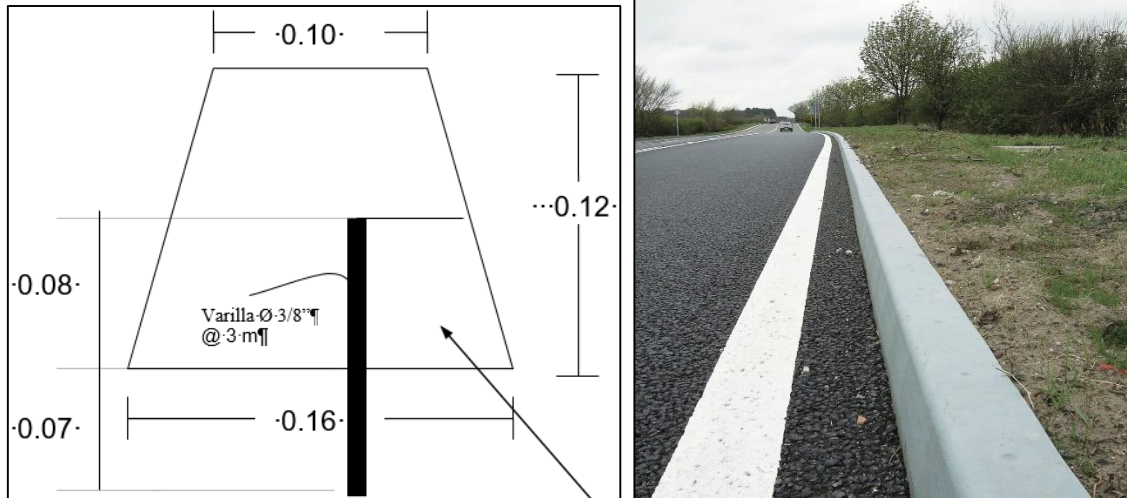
Diseño y dimensiones de bordillo a construir.
